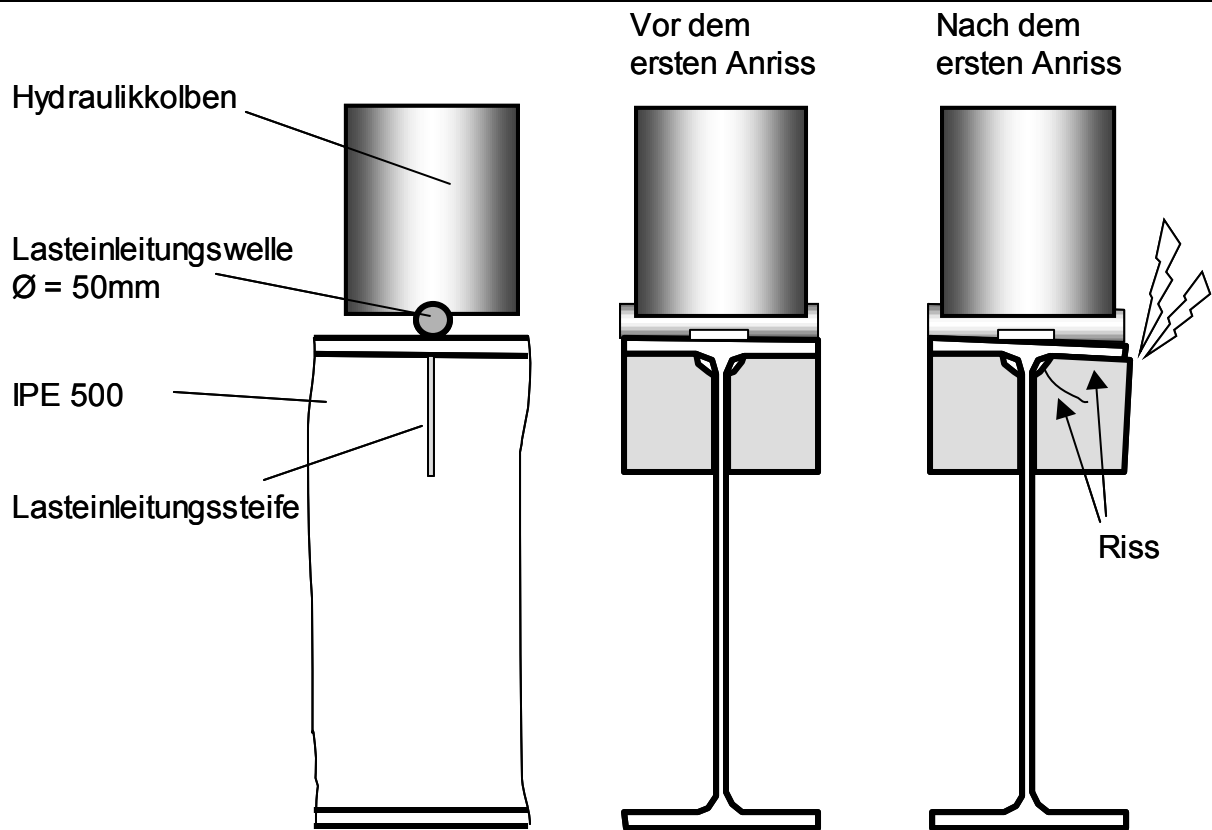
Lasteinleitung und Verlagerung der Beanspruchung der Steifen vor und nach dem ersten Anriss
